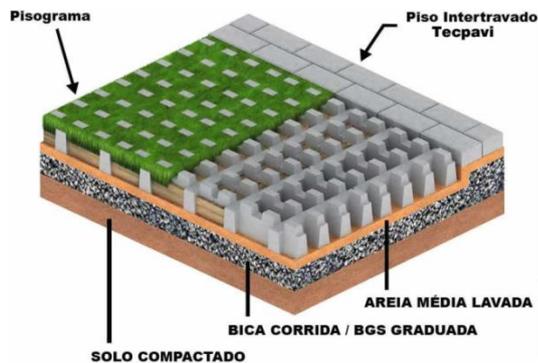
Sistema de projeto do Bloco de Concreto Vazado.
